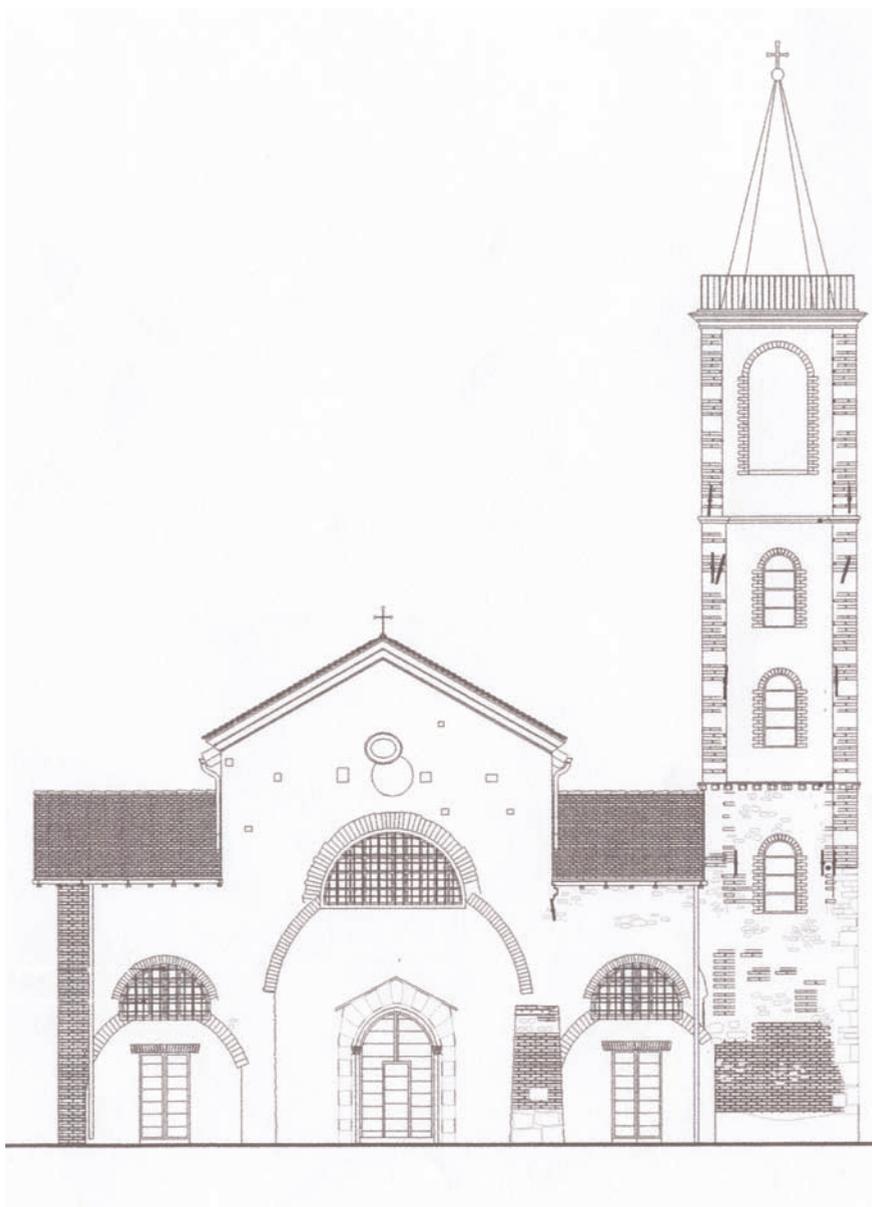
Tiglieto, chiesa di Santa Maria, prospetto est
